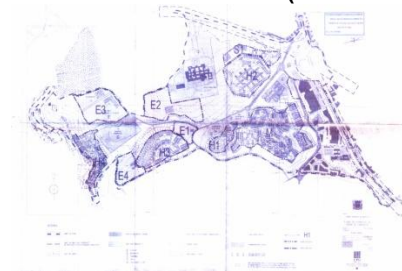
PLANO DE PORMENOR DA ÁREA CENTRAL OUTORELA - PORTELA
